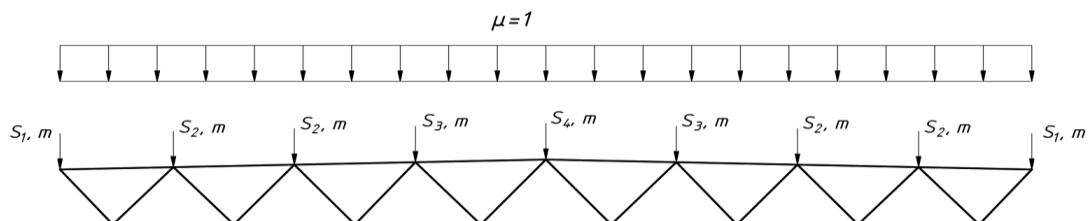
Схема приложения нагрузки от веса снегового покрова
